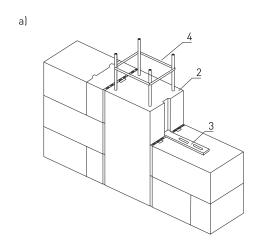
Соединение заполняющей стены из блоков YTONG с железобетонной колонной с помощью соединительных элементов YTONG LP30
